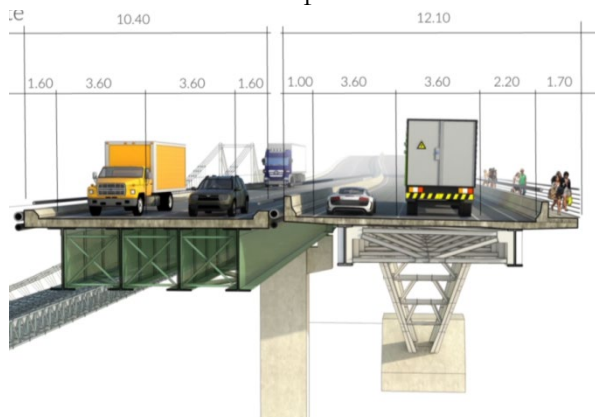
Secciones transversales del puente existente (izquierda) y del nuevo (derecha)
